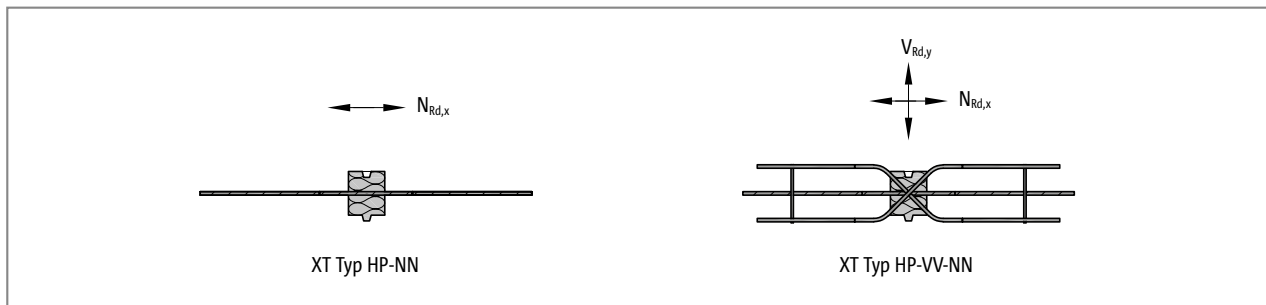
Schöck Isokorb® XT Typ HP: Typenauswahl
